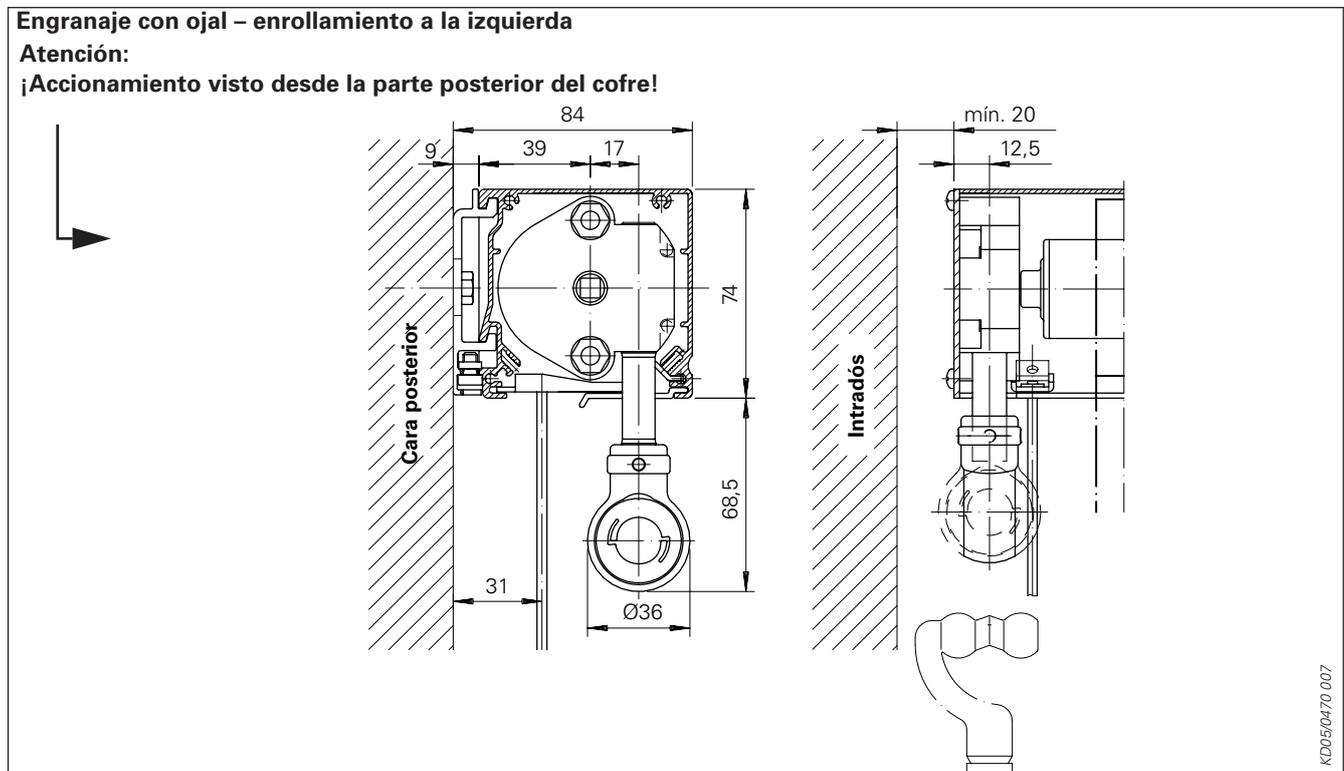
Engranaje con ojal – enrollamiento a la izquierda
